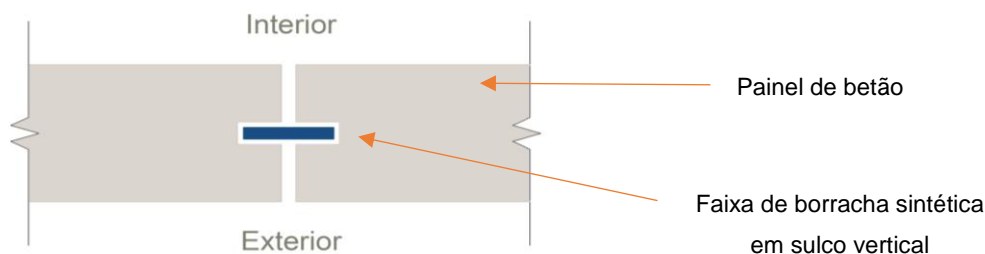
Planta de junta vertical – Esquema de junta de drenagem (Adaptado de Marques, 2012)
